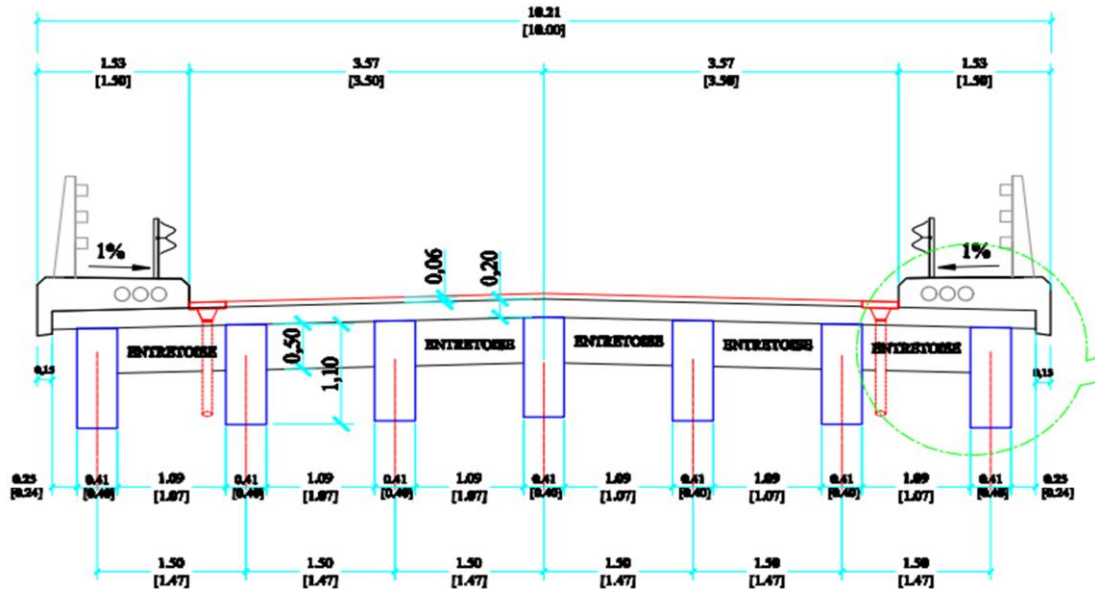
Coupe transversale sur le tablier à poutres en BA
